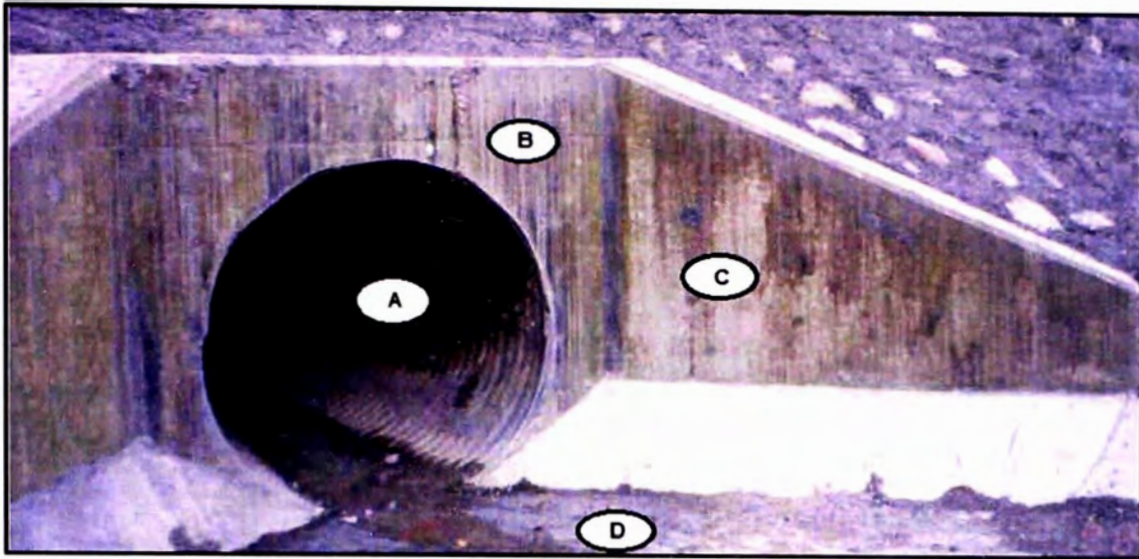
Componentes de las alcantarillas, donde "A" es la Alcantarilla propiamente dicha, "B" es el Cabezal, "C" son los Aleros y "D" es la Plataforma.
